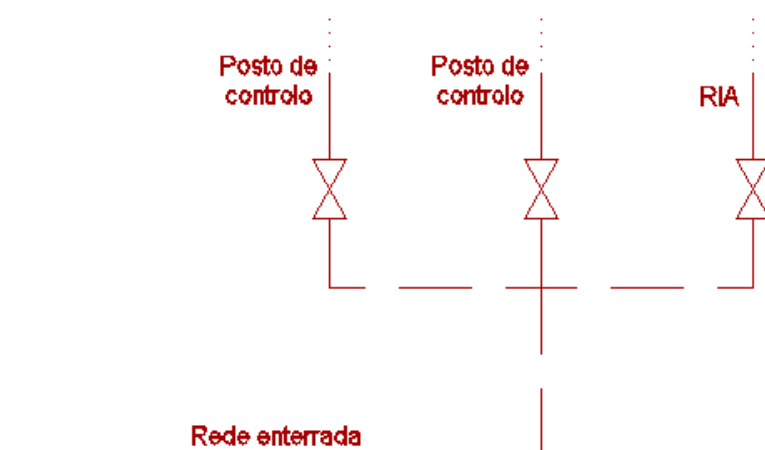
Zoom da área de pormenor 2 (coluna e barrilete).
